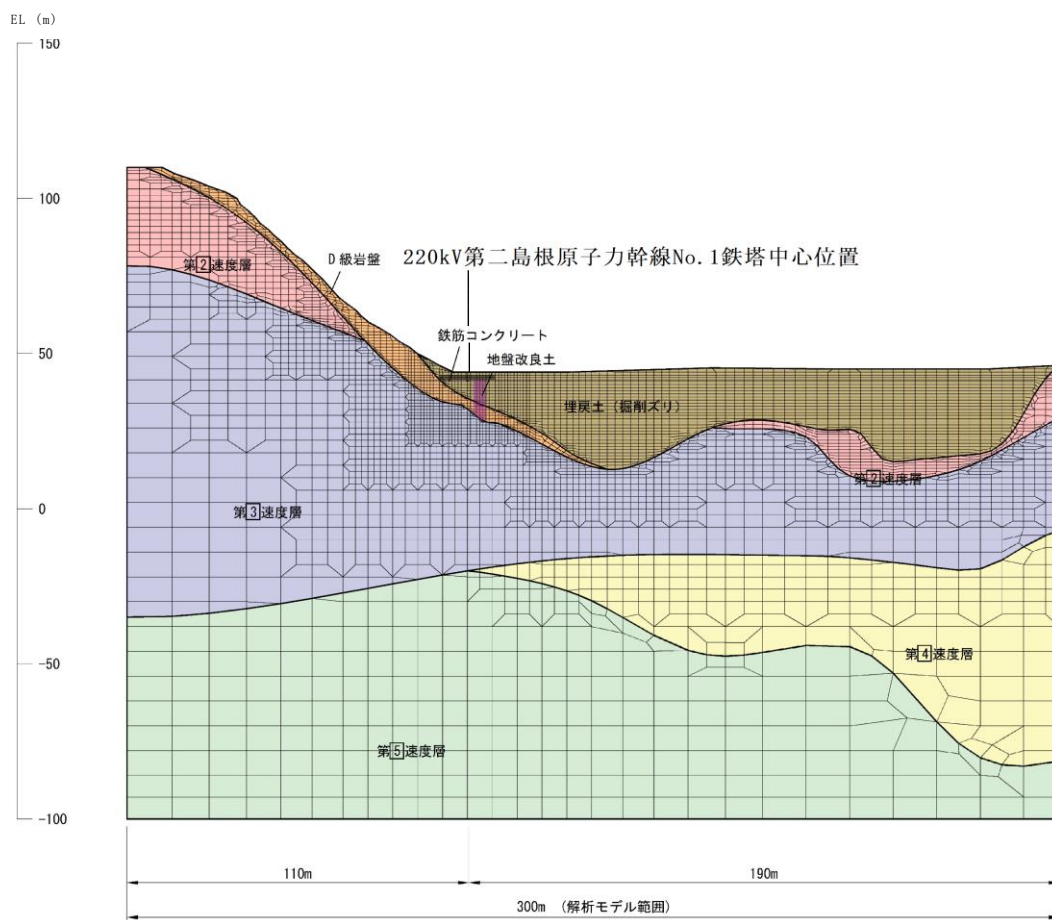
改良地盤の配置図 (図 2-1 A-A 断面)
